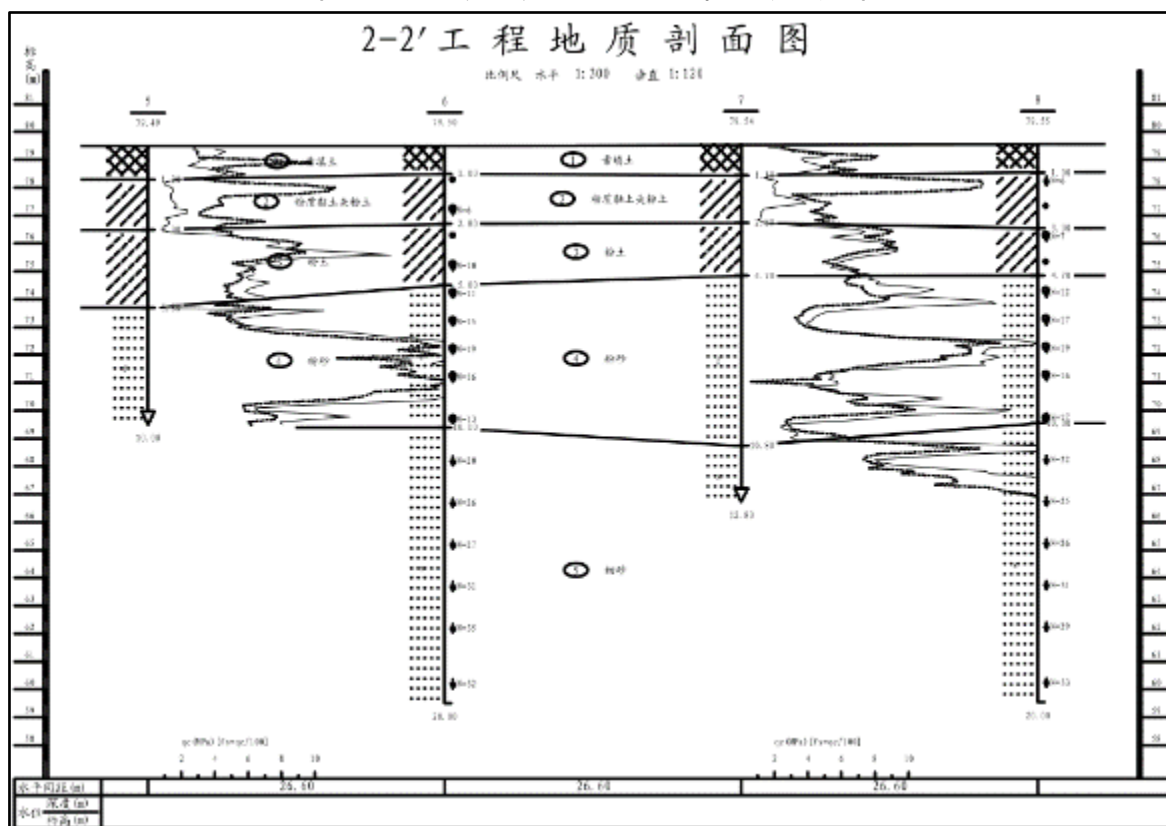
项目厂区 2-2' 工程地质剖面图
